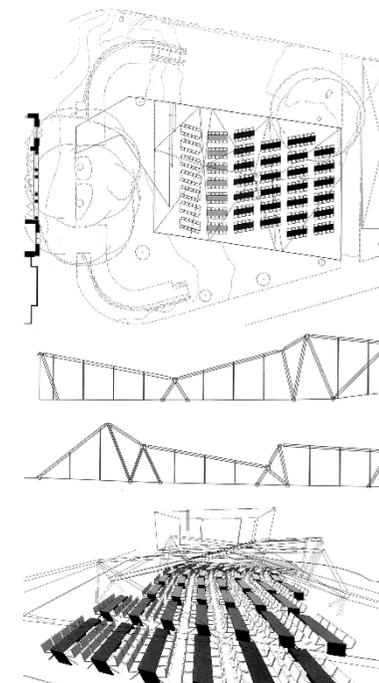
(1ª) Planta del pabellón. (2ª) Alzado. (3ª) Axonometría.
